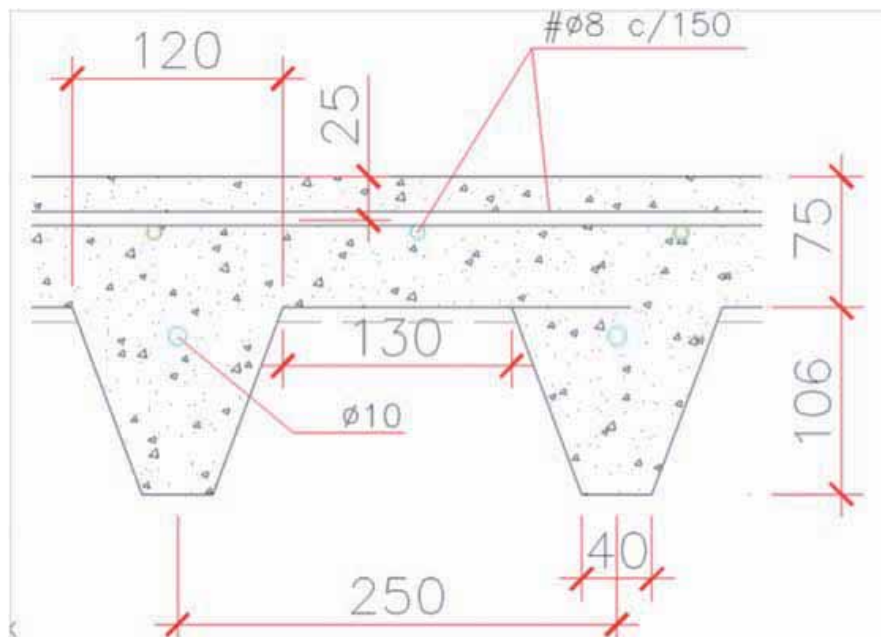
Detalle del armado de compresión y de los nervios del forjado mixto ligero.
